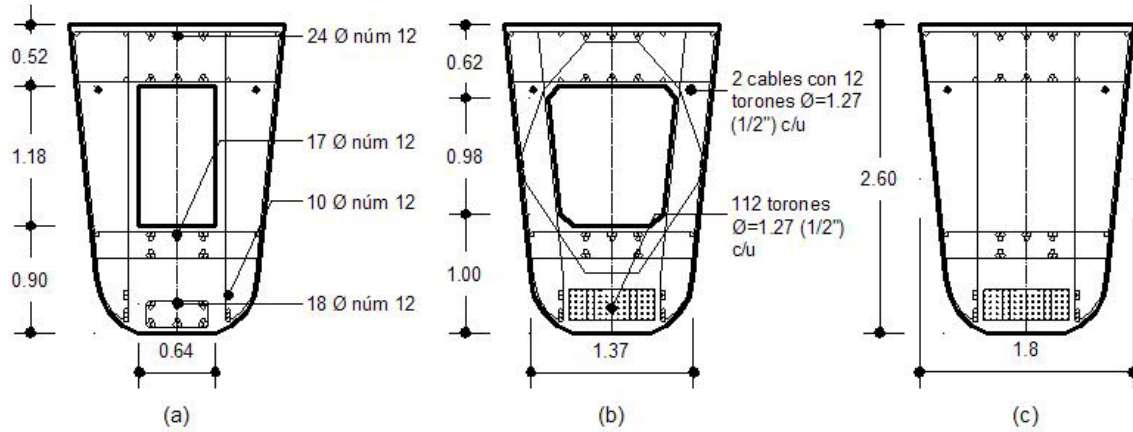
Dimensiones y armado de los cabezales. (a) Sección tipo cajón con paredes ortogonales. (b) Sección tipo cajón con paredes inclinadas. (c) Sección maciza.
